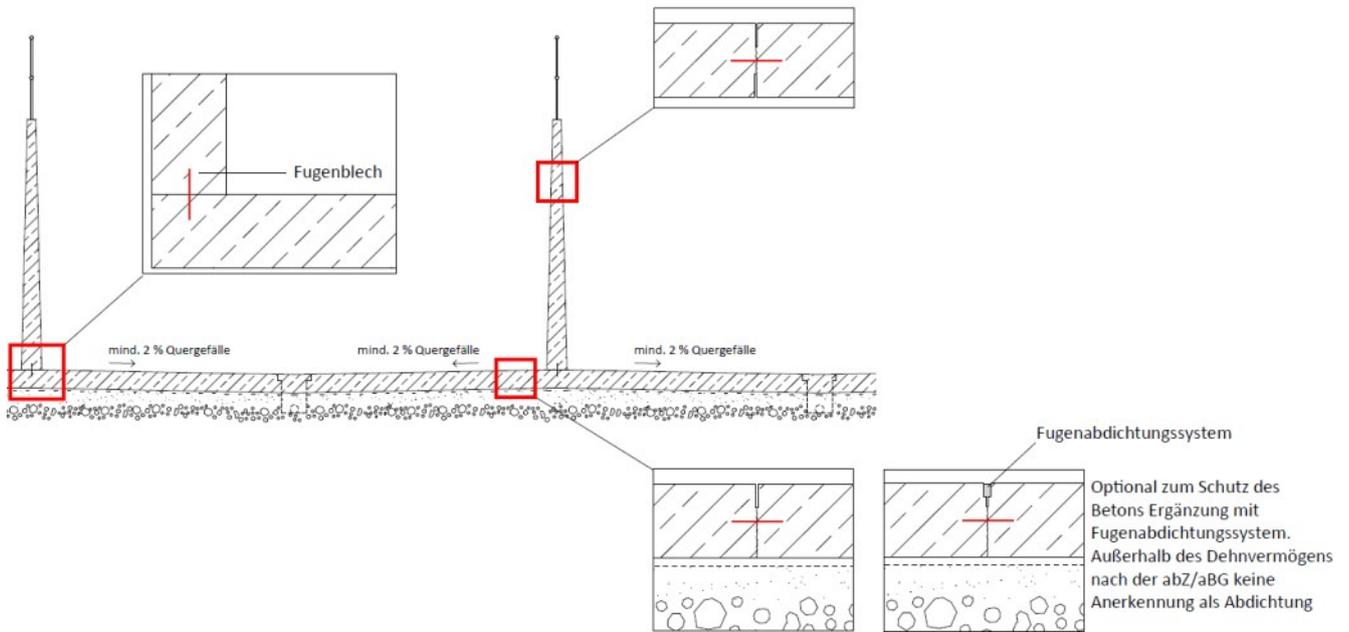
Ortbeton - Ortbeton (gerade Wand) - Verwendung von Fugenblechen (siehe auch Kapitel 6.1)
